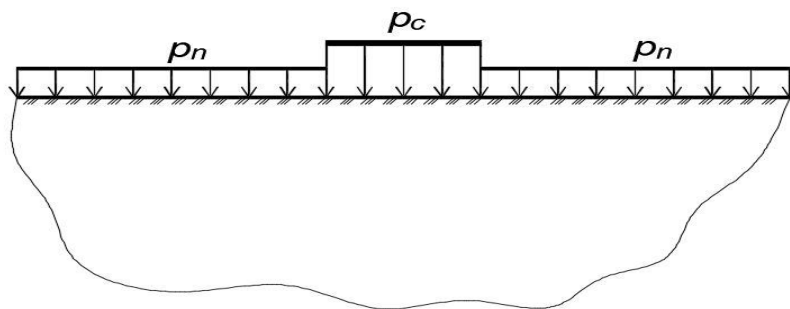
Грунтовое основание под действием нагрузки от сооружения и боковой пригрузки
